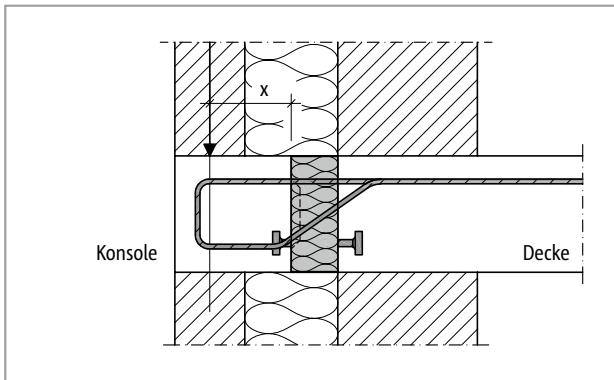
Schöck Isokorb® T Typ O: Konsole mit Verblendmauerwerk
